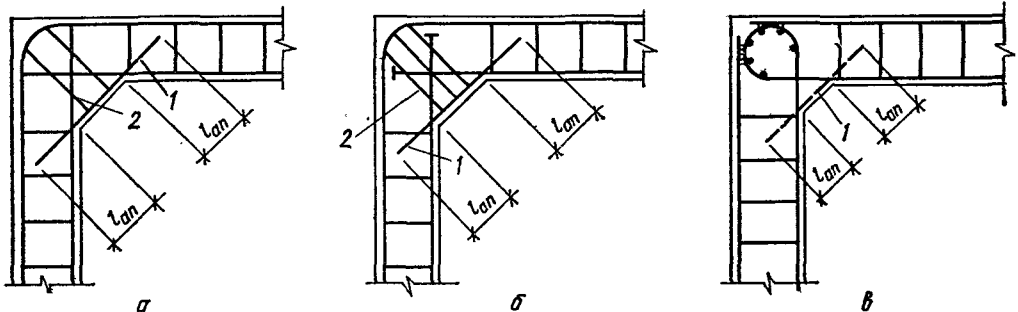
Армирование крайних верхних узлов рам сварными сетками при растянутых гранях входящего угла:
